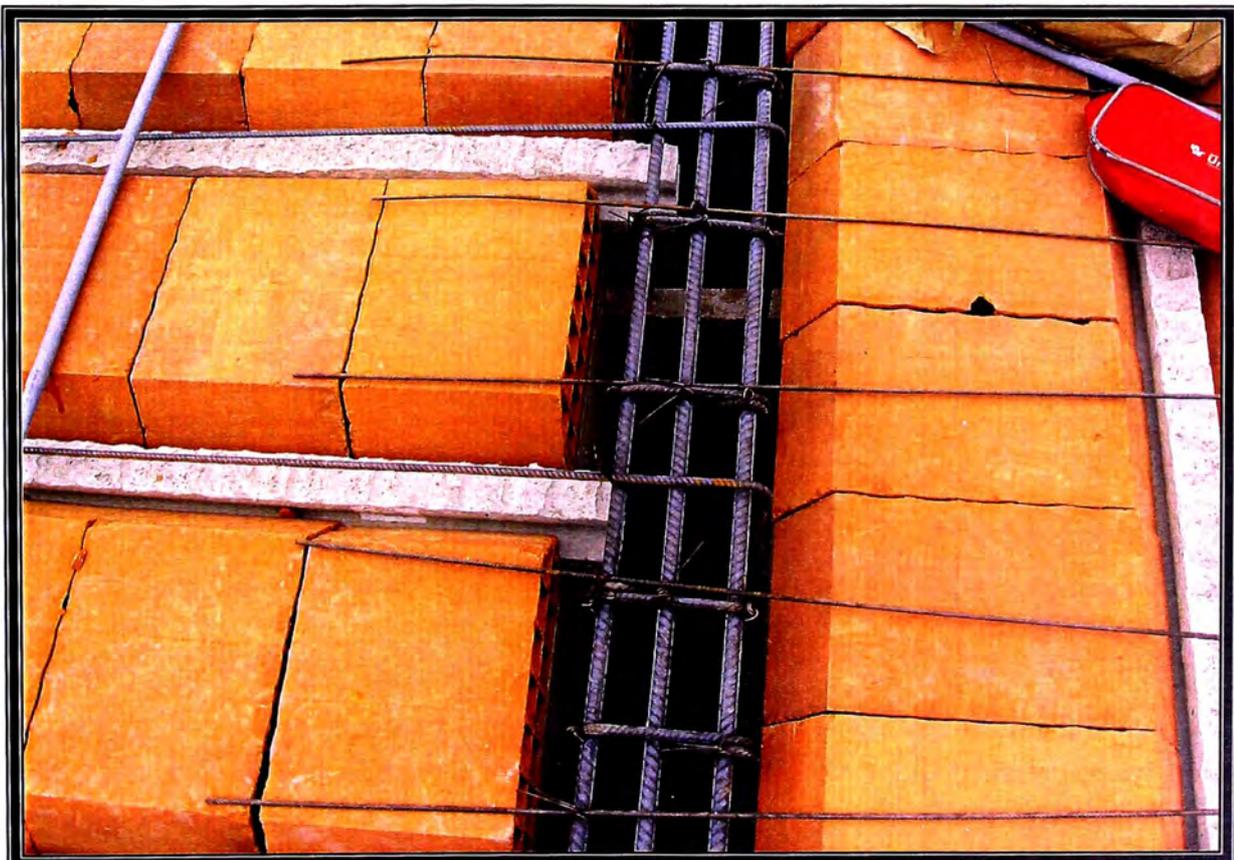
LAS VIGUETAS INGRESARÁN ENTRE 7,5 Y 10 CM EN LAS VIGAS. SE OBSERVA EL ACERO NEGATIVO Y DE TEMPERATURA RESPECTIVAMENTE.
